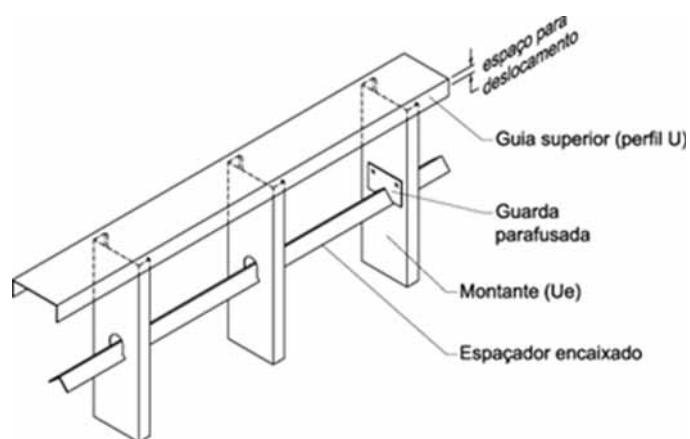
Espaçador instalado entre montantes / Fonte: Adaptado de DIETRICH, 2010
